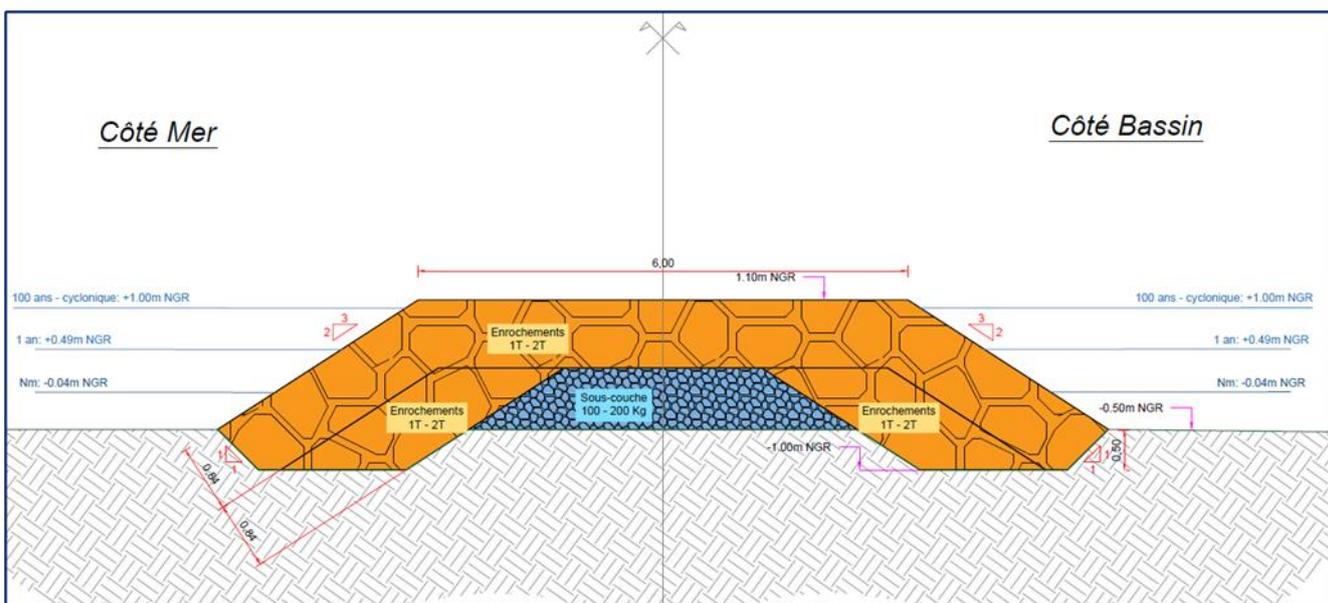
Coupe type de l'enrochement – Tronçon de retour
